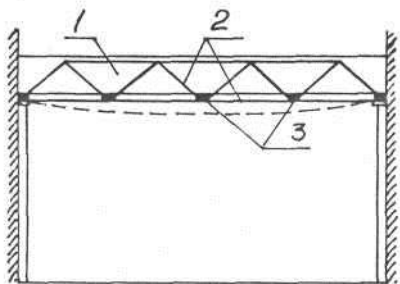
(1 — усиливаемая балка, 2 — усиливающая ферма, 3 — прокладки)
